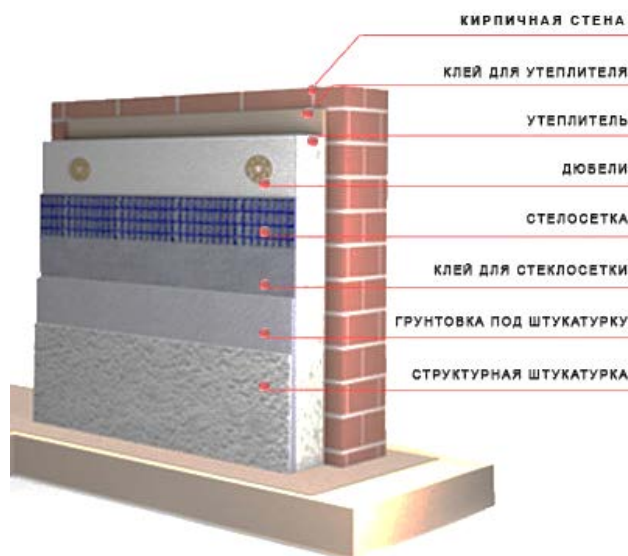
Фасадное утепление наружной стены жилого дома из кирпича
